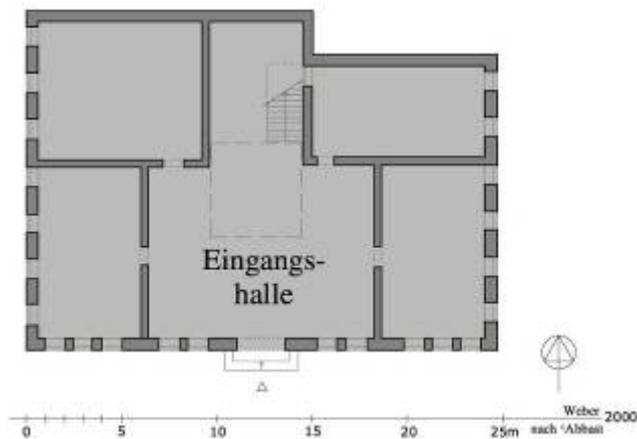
Gerichtshof [12], Grundriss EG
